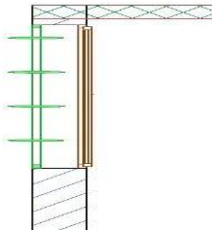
Coupe verticale sur le brise-soleil de 30 cm (source Archicad)
